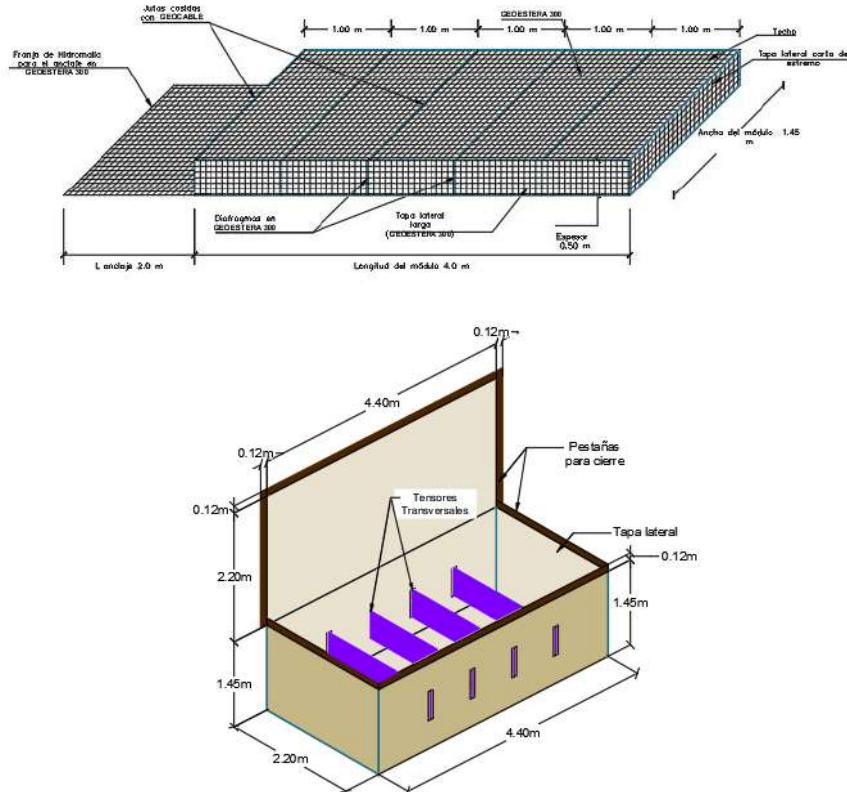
Detalles de la protección para la tubería cercana a la Bocatoma
